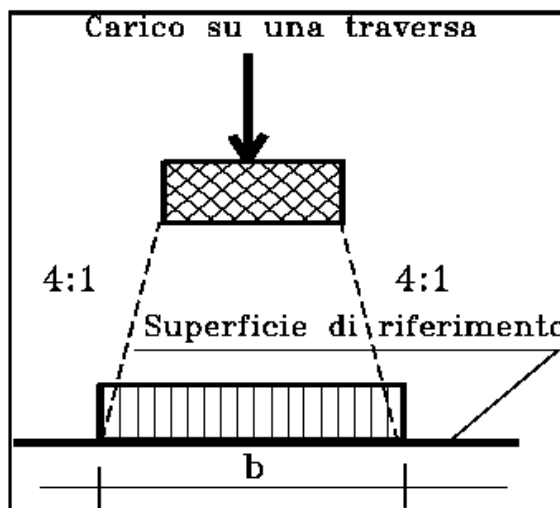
Distribuzione longitudinale dei carichi attraverso il ballast
